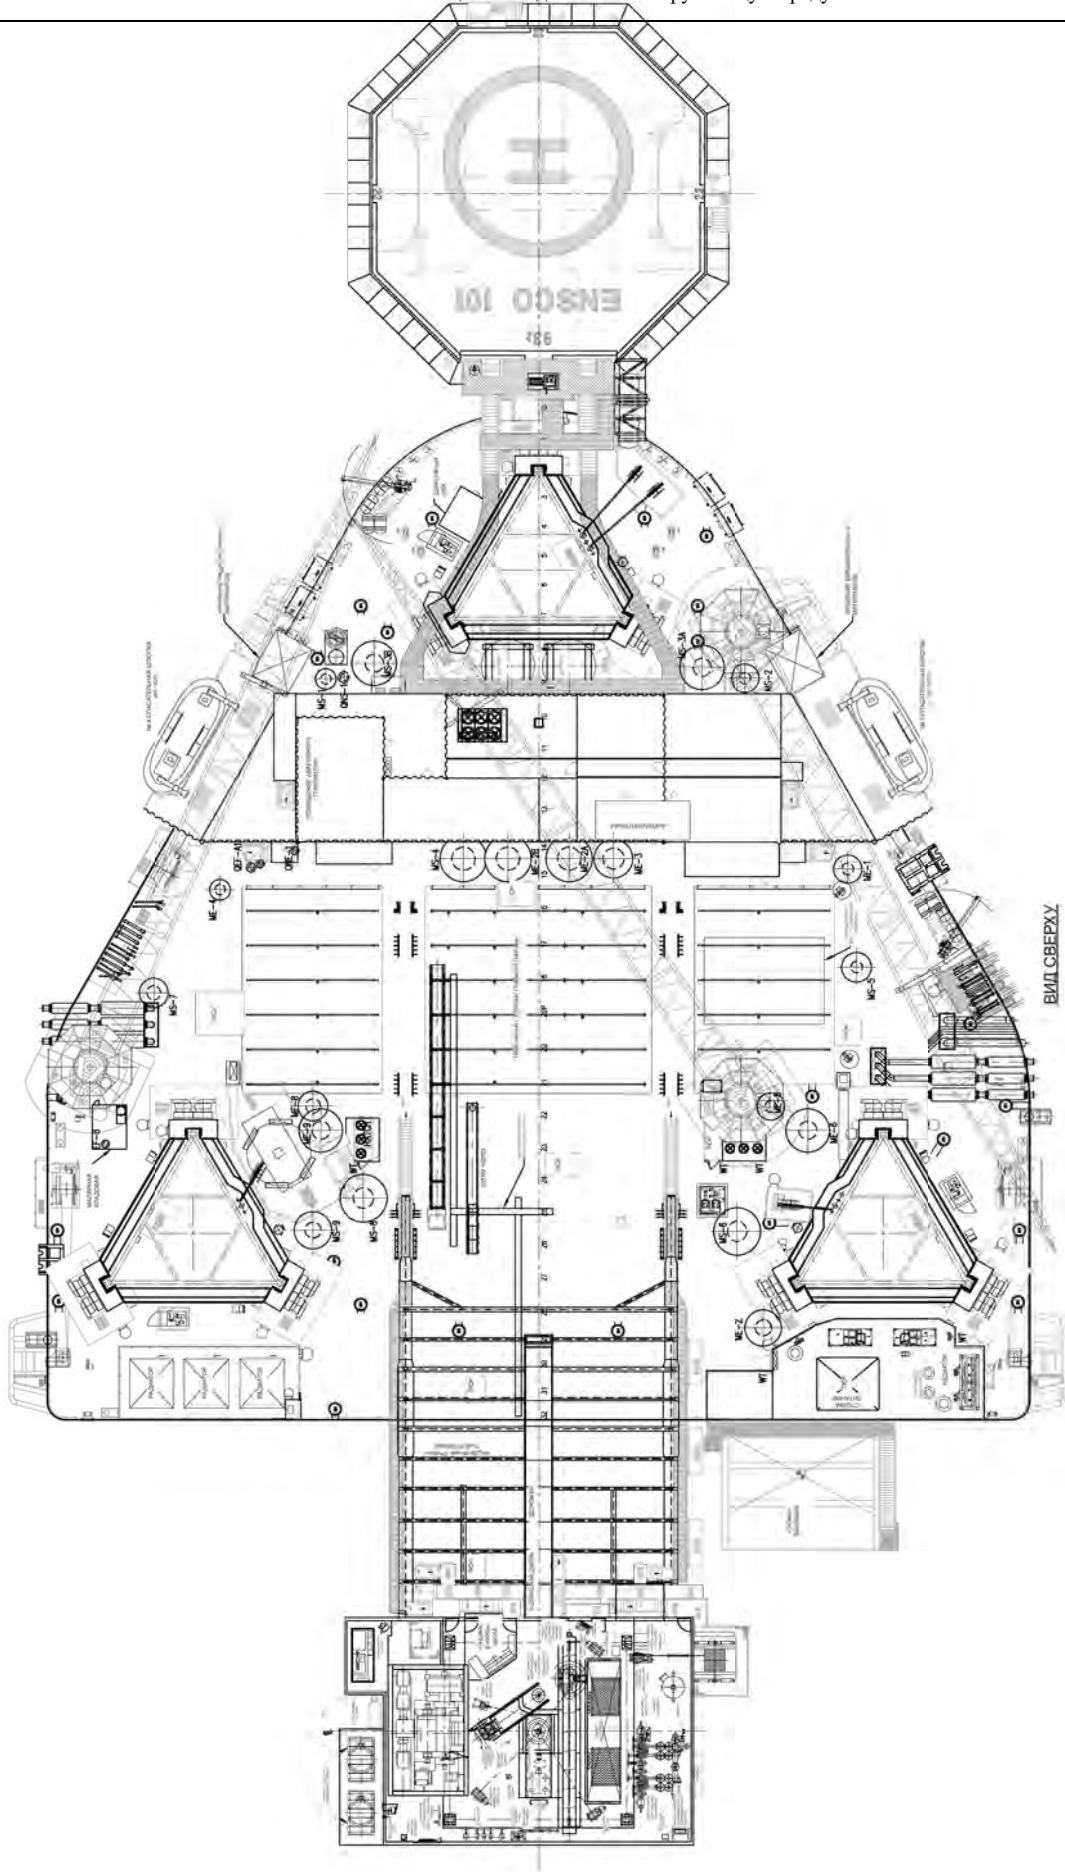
Схема общего расположения оборудования. Вид сверху
